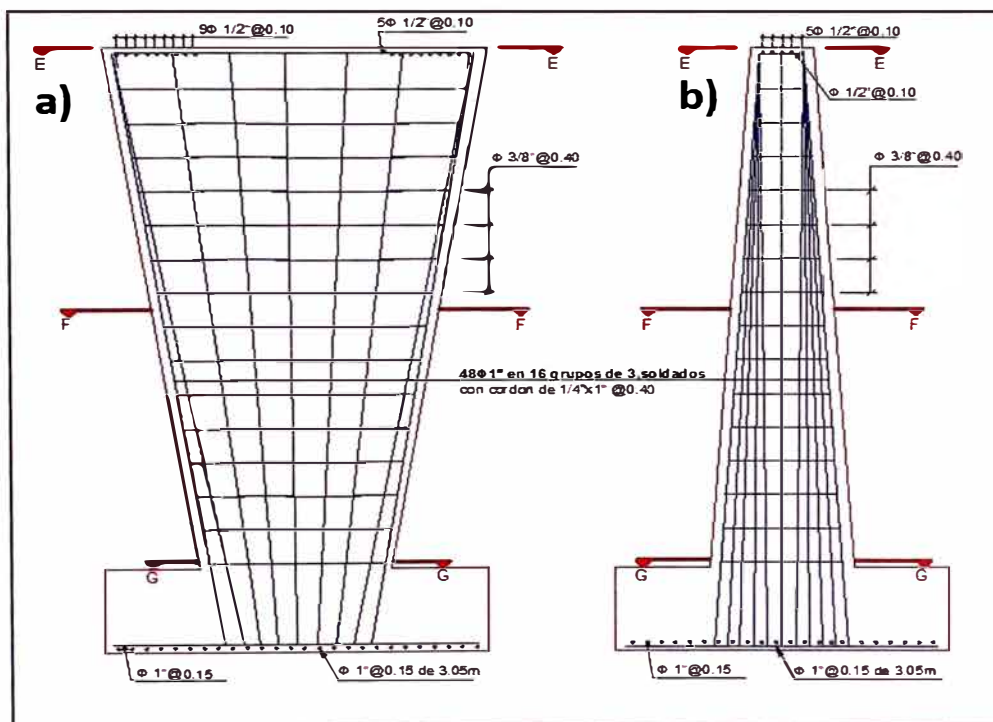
a) Corte C – C y b) Corte D - D de la vista en planta
